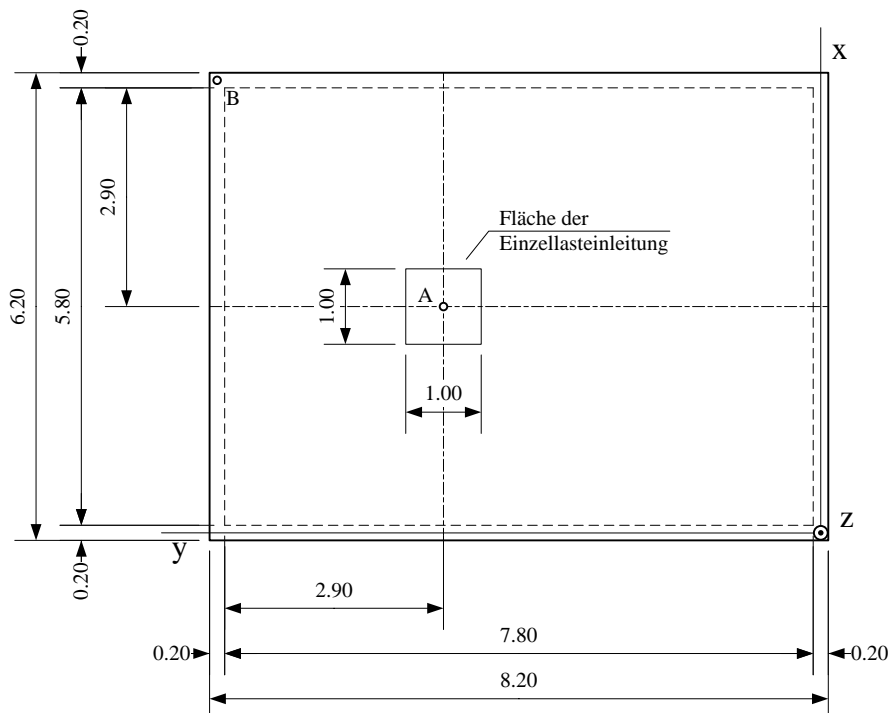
Grundriss der in Aufgabe 3 behandelten Stahlbetonplatte, 1:100.
